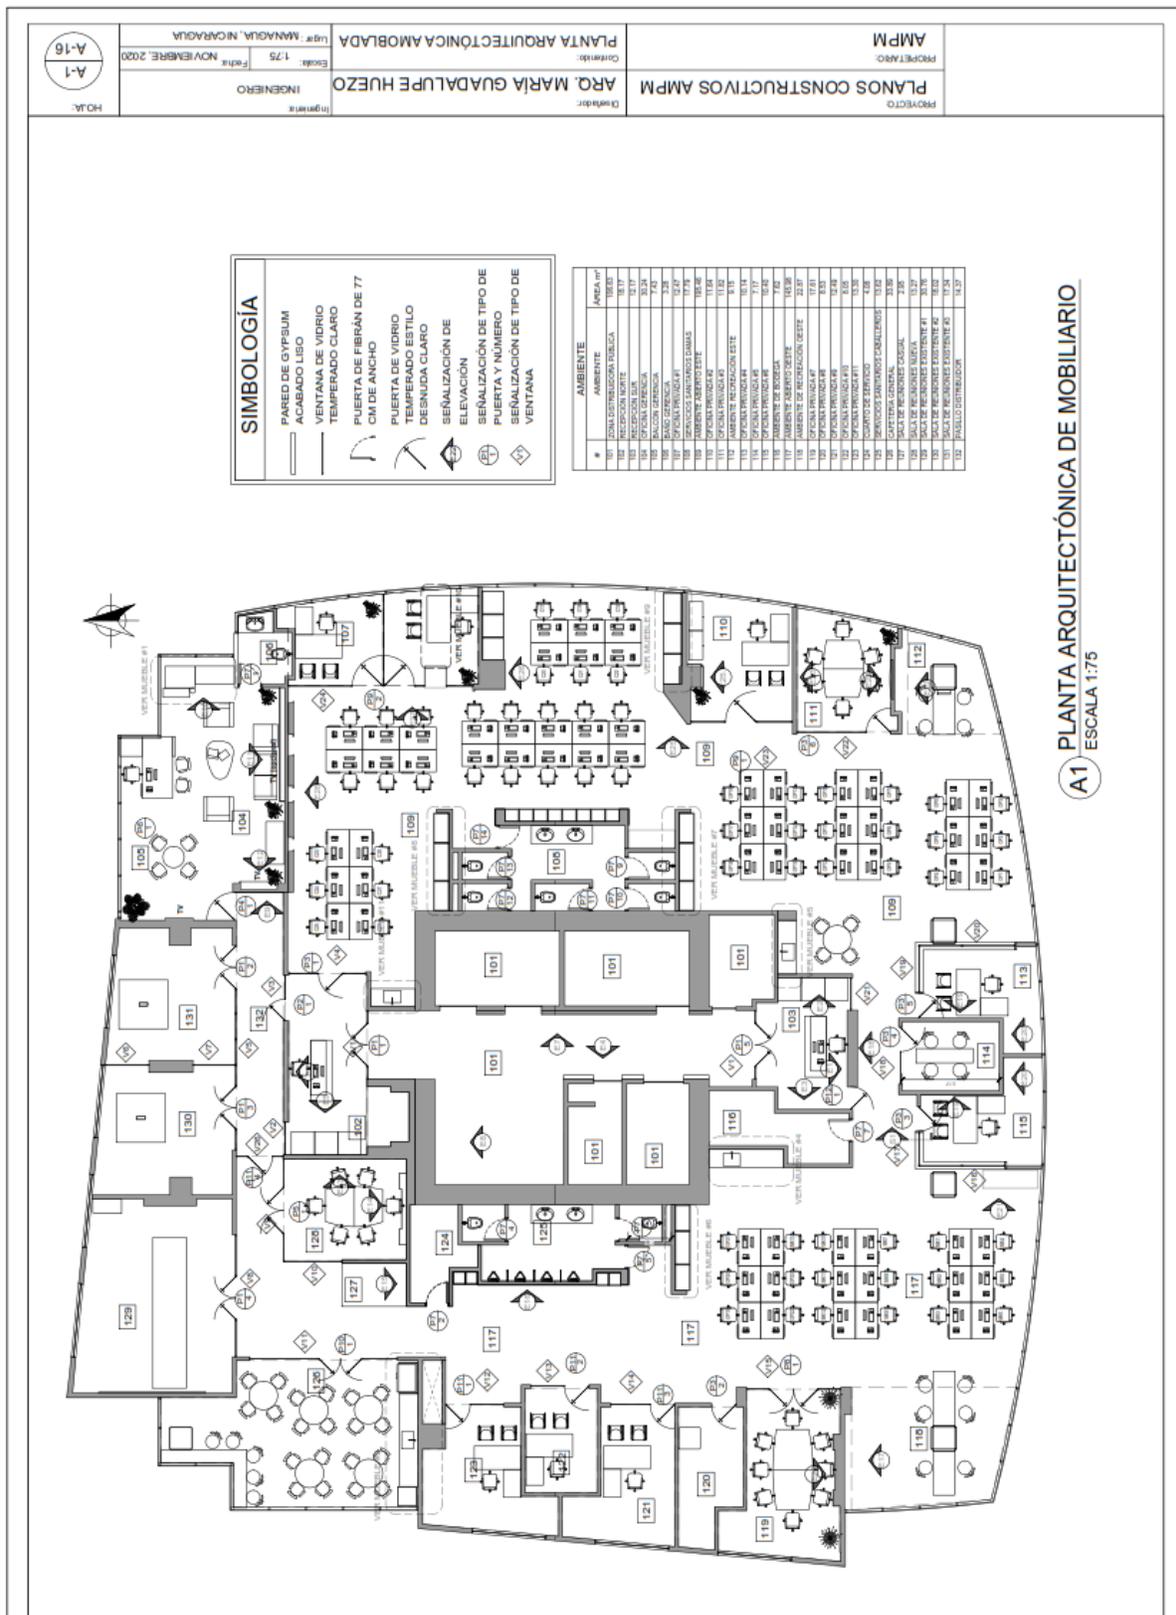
Planta arquitectónica de las oficinas de AMPM Centroamérica
